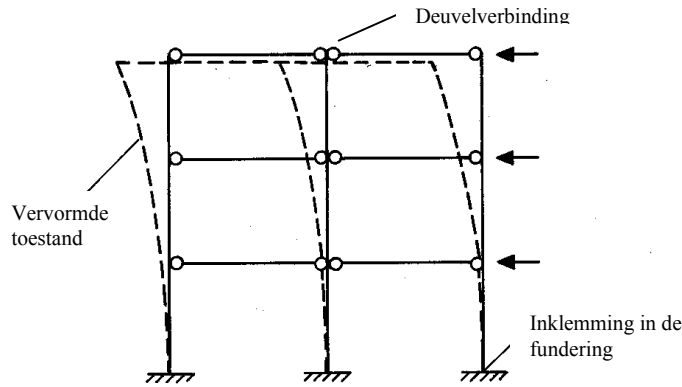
Vervormingen van een niet geschoorde constructie
